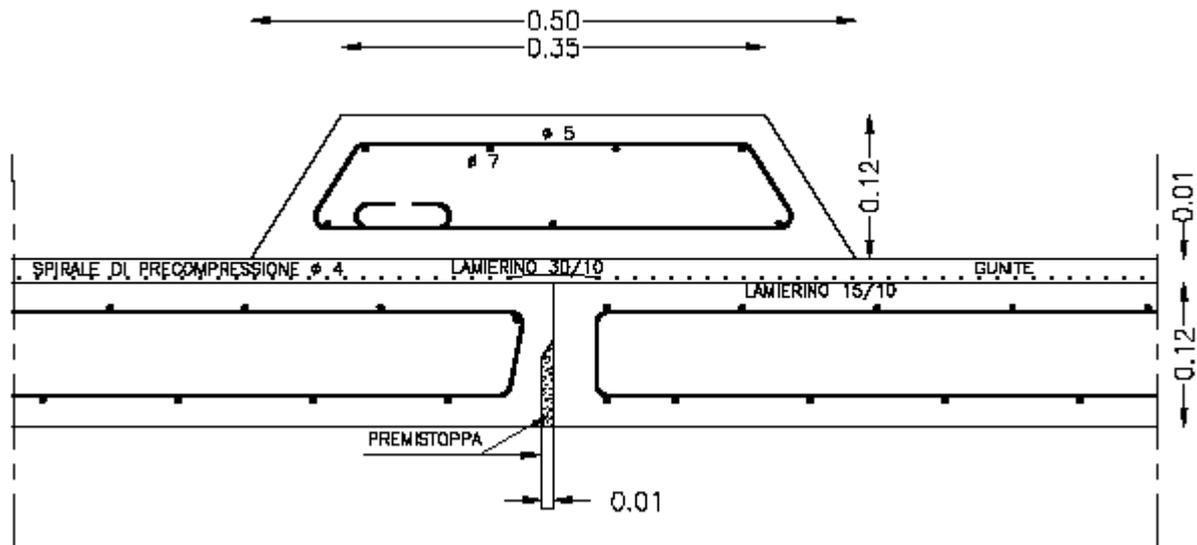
sezione di dettaglio dell’accoppiamento tra i tubi della condotta forzata in c.a.p.
